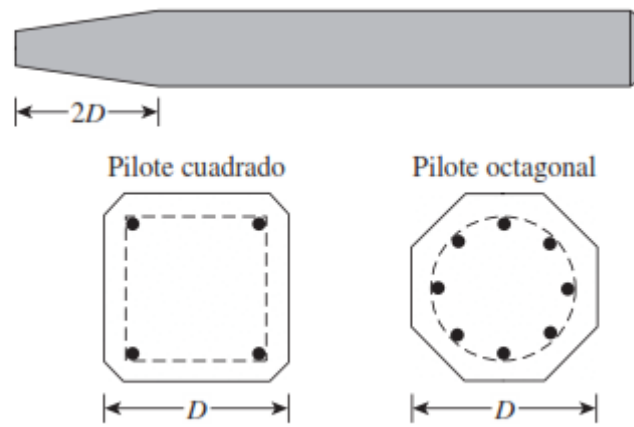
Pilotes precolados con refuerzo ordinario, Adaptado de “Fundamento de ingeniería de cimentaciones”, por Braja M. Das (2012)
